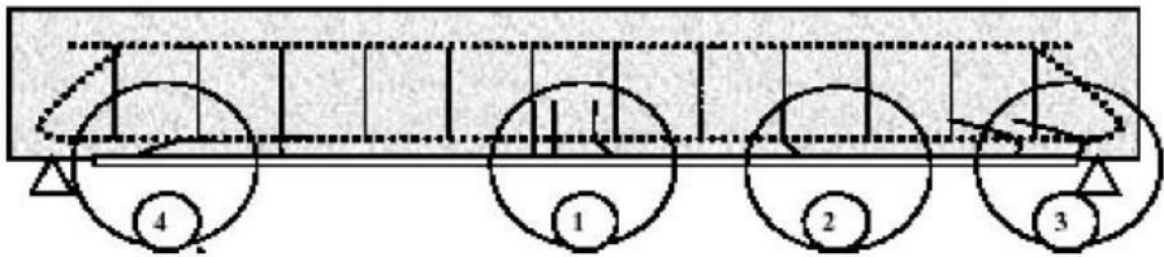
comportement structural d'une poutre renforcée. (Bouabdellah,2023)
